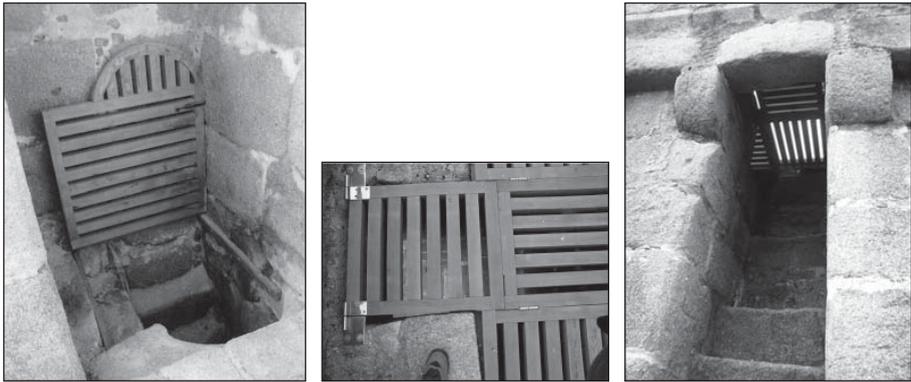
Detalles de las trampillas que protegen las escaleras de conexión de los adarves.
